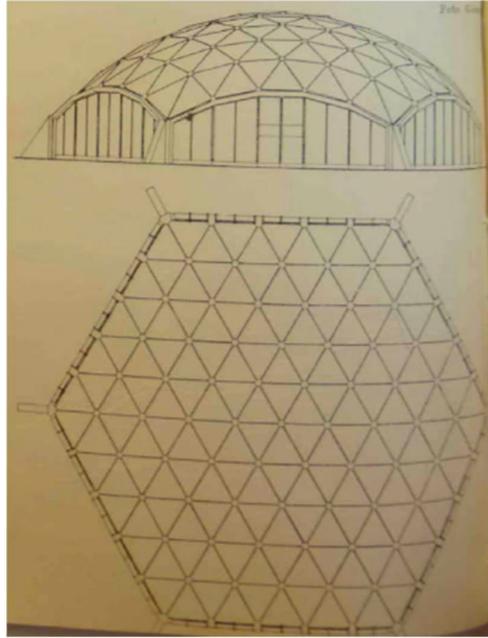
pabellón IKA. Vista y Planta de techos. Fuente: Revista SCA nº379-380 (Industrias Kaiser Argentina, 1962:s/d).
